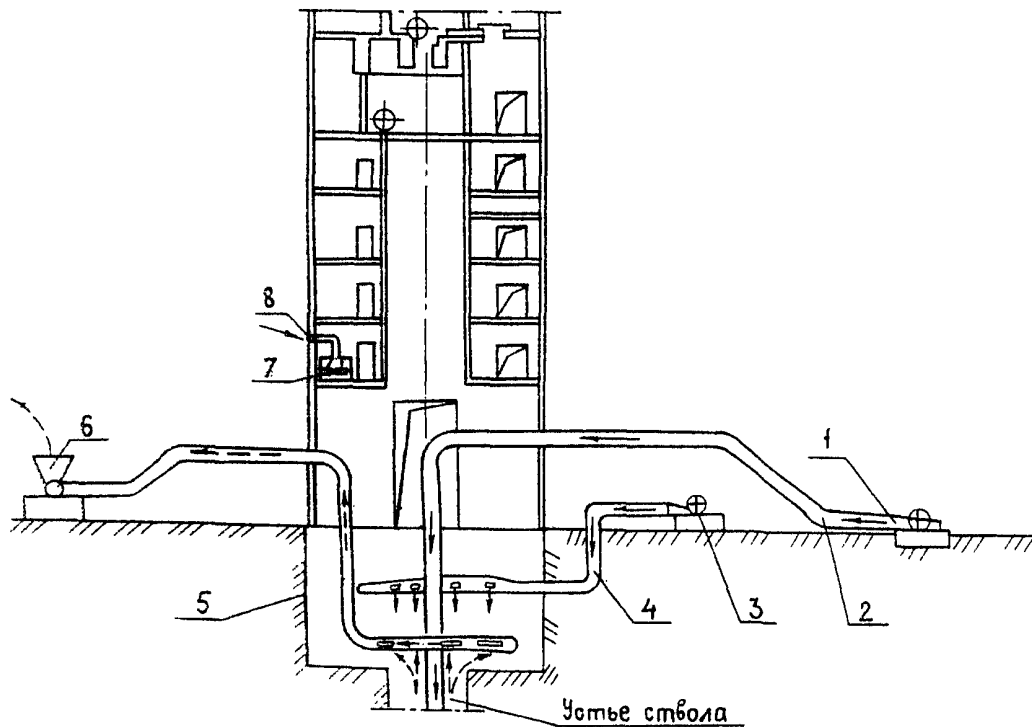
Схема проветривания башенного копра при проходке ствола:1,2-вентилятор и трубопровод для проветривания ствола;3,4-вентилятор и короб для образования воздушной завесы;5,6-трубопровод и вентилятор отсасывающей установки;7-кожух для укрытия проходческого оборудования; 8-вентилятор для обдува электроприводов
